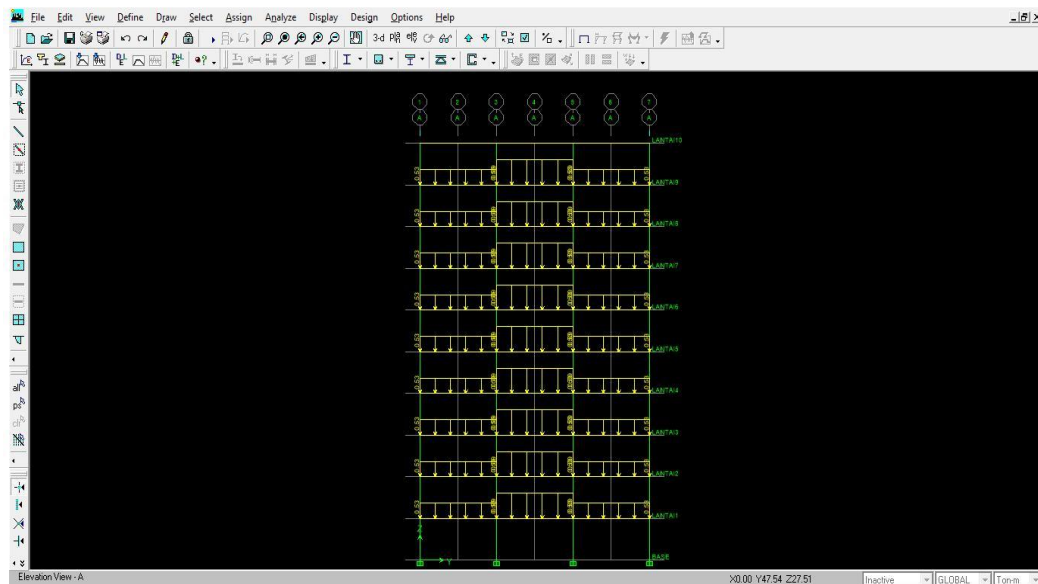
Denah Tampak Samping Arah y Struktur *Shearwall* Model 3
